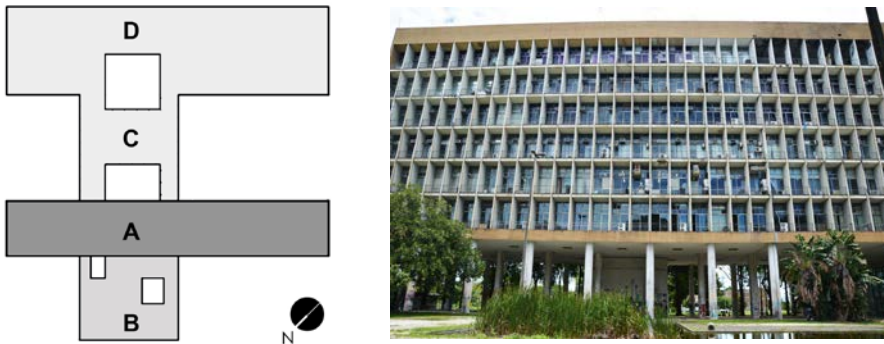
Identificação da fachada sudeste do bloco A do Edifício JMM (esquerda); panorama da fachada sudeste (direita).
